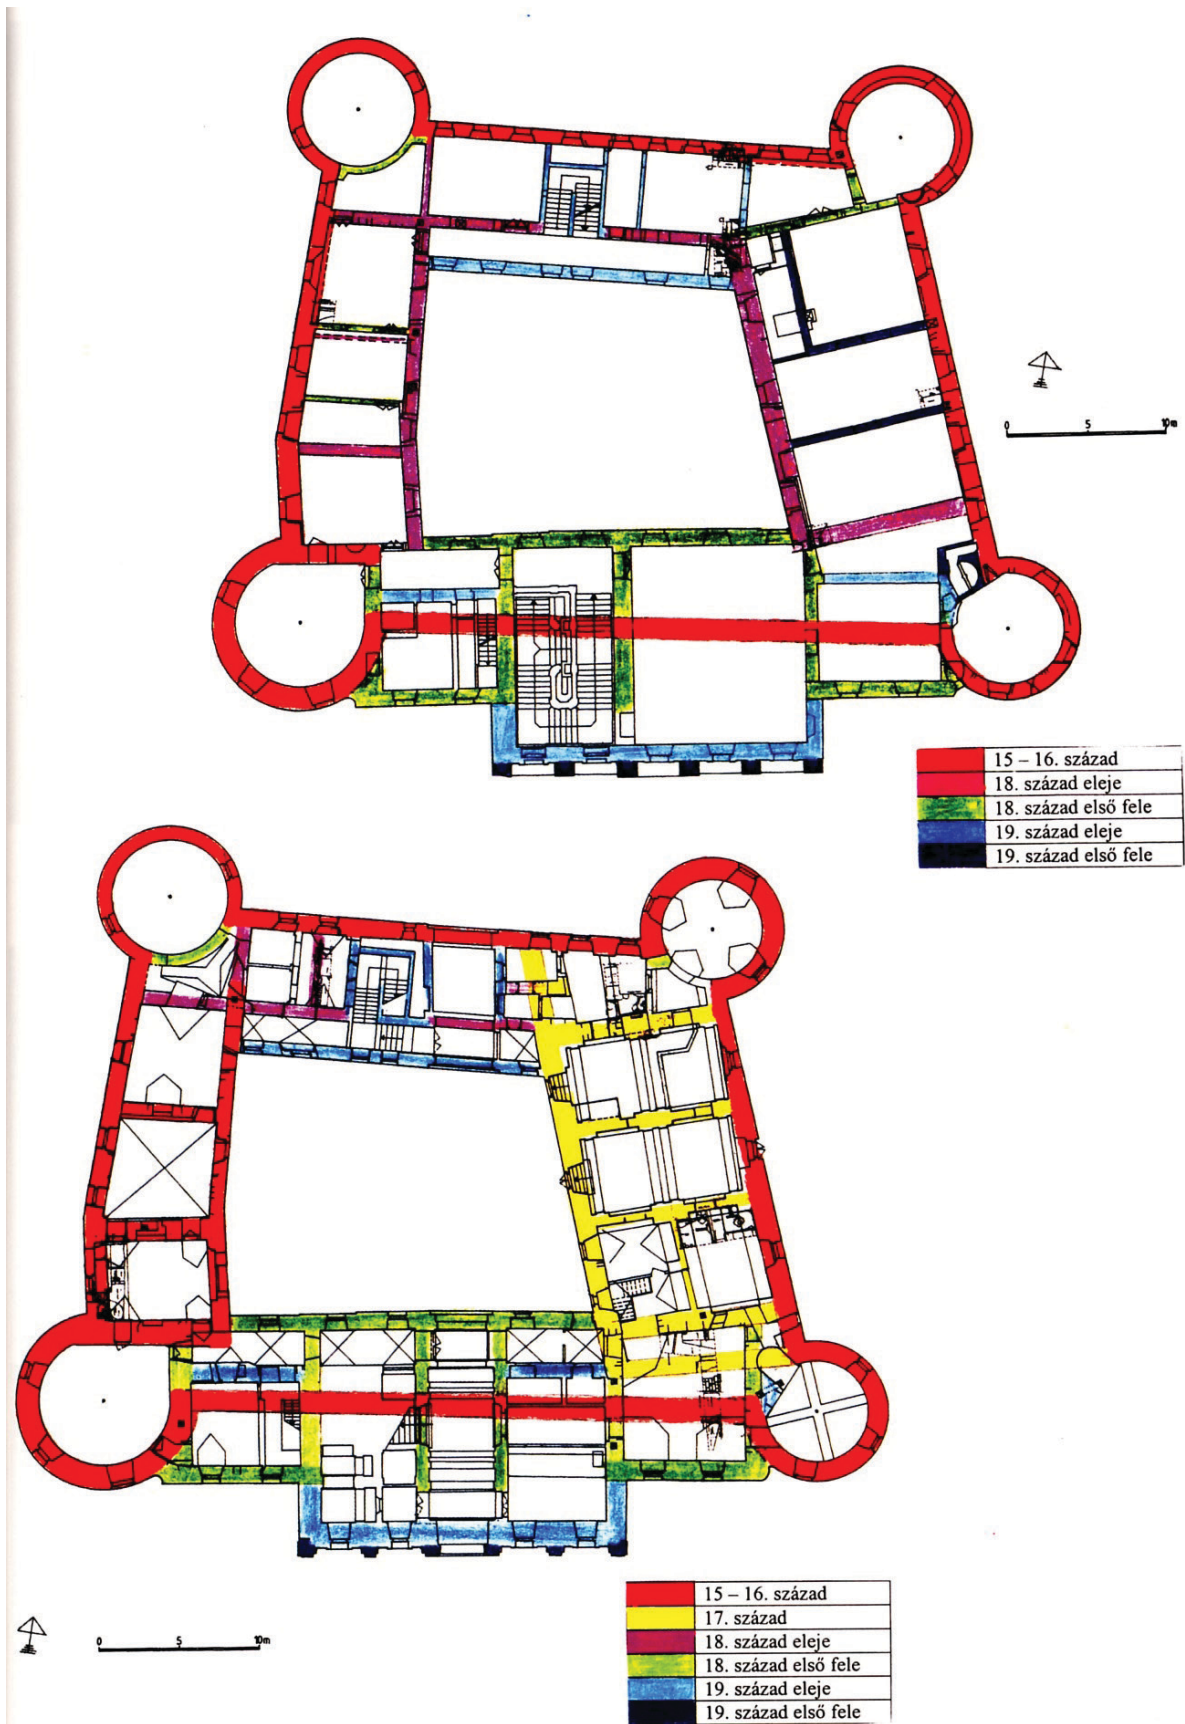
Körmend, Burg. Die Grundrisse nach der Bauforschung mit den Bauperioden (nach A Batthyányak évszázadai. [Die Jahrhunderte Batthyáns] Körmend, 2006. Abb. XVII.)
